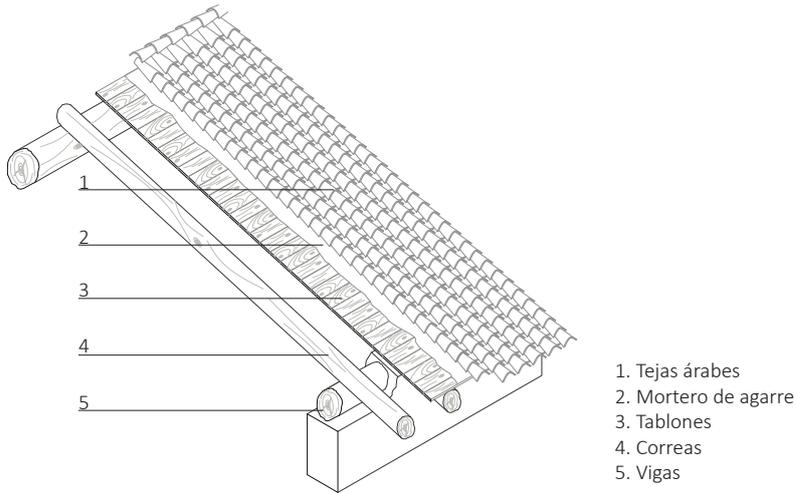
Detalle cubierta correas y tablones Fuente: propia
